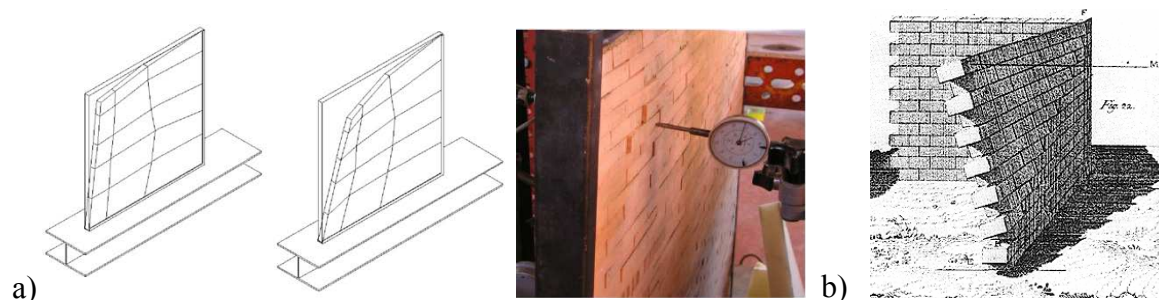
Mécanisme d'effondrement d'un mur supporté sur deux bords adjacents : a) test de [ZUC 2008] ; b) proposé par Rondelet.
